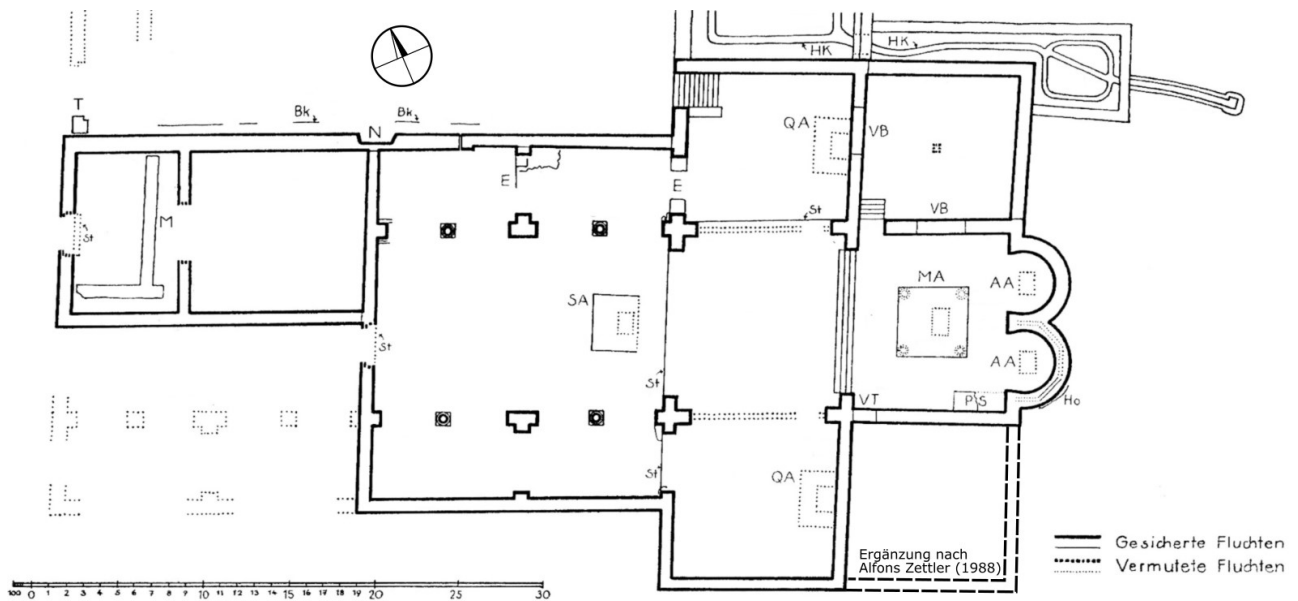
Reichenau-Mittelzell: Der Grundriss des im Jahr 816 geweihten Heito-Baus
